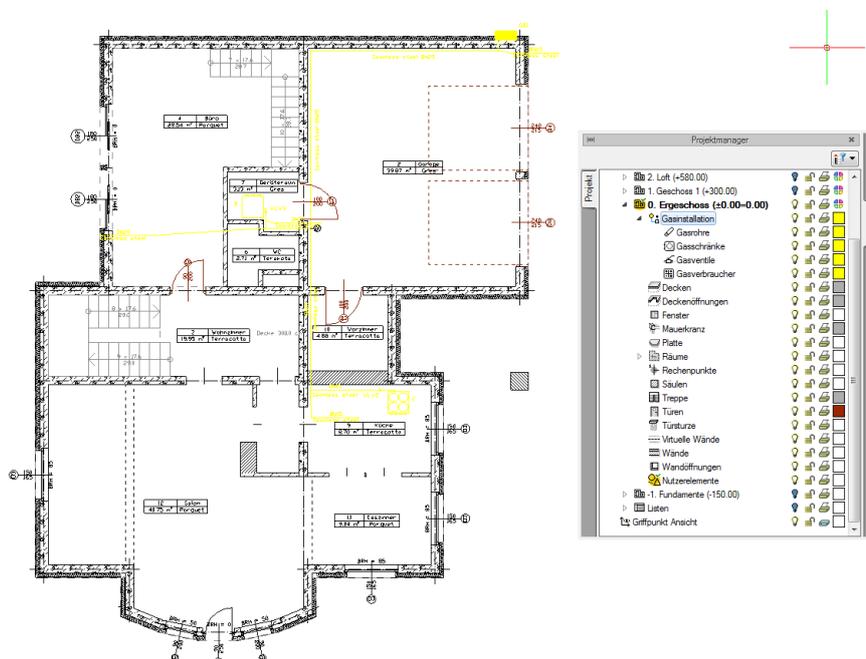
Grundriss eines Geschosses mit allen sichtbaren Elementen
